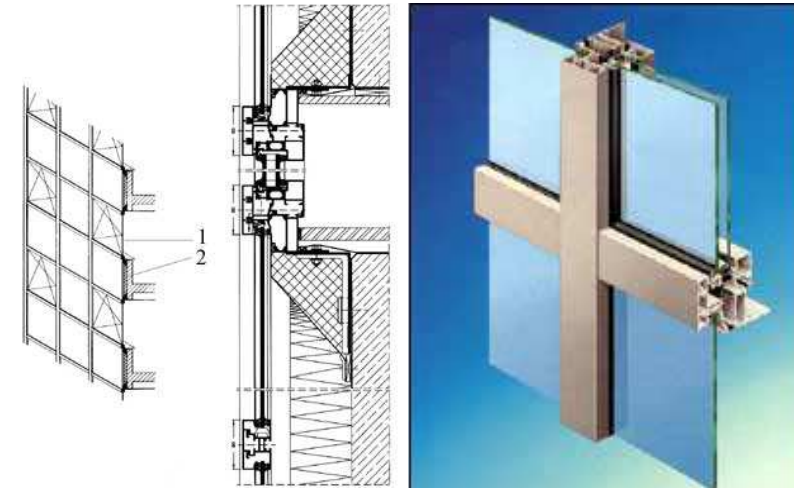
Конструкция тепло-холодной фасадной системы (облицовочный фасад) фирмы SCHUCO.
